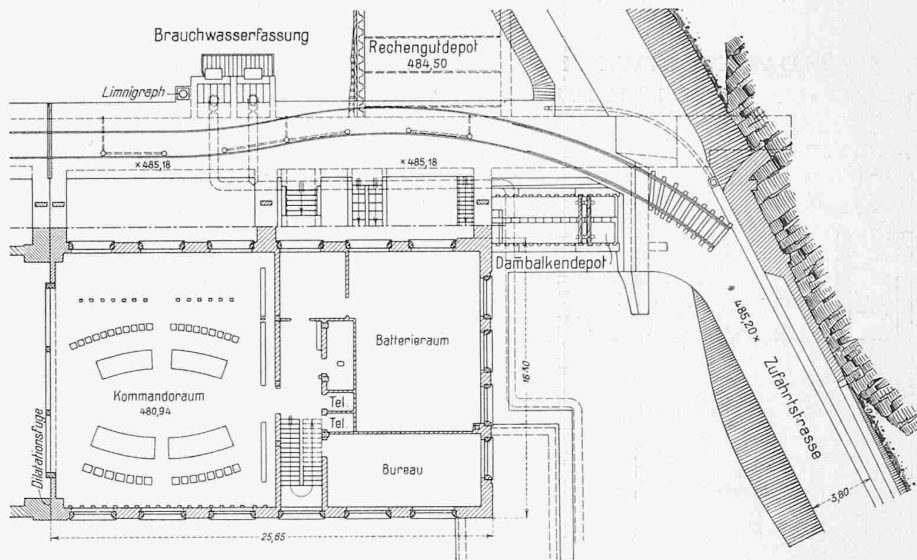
Maschinenhausanbau-Horizontalschnitt über Kote 480,94. — Masstab 1 : 400.
